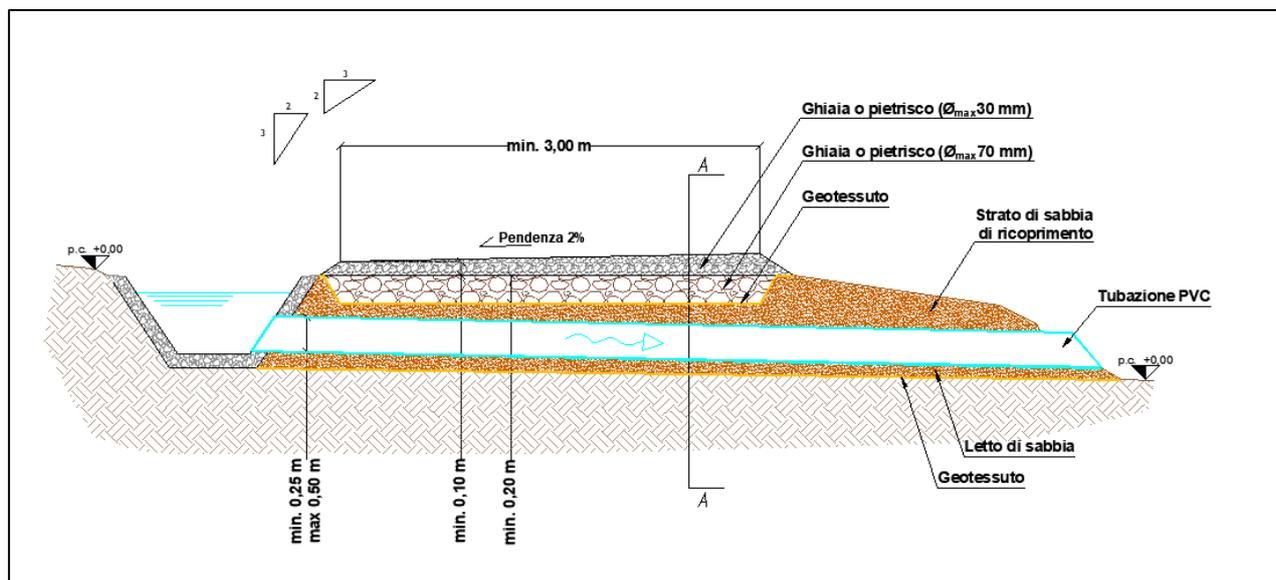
Tipologica sezione stradale viabilità interna con attraversamento tubo di drenaggio acque meteoriche
